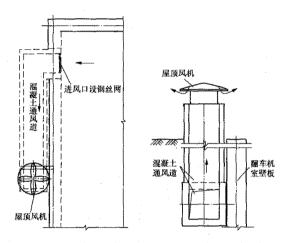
翻车机室地下部分 图 5-10 翻车机室地下部分 通风平面图 (二) 通风剖面图 (三)
